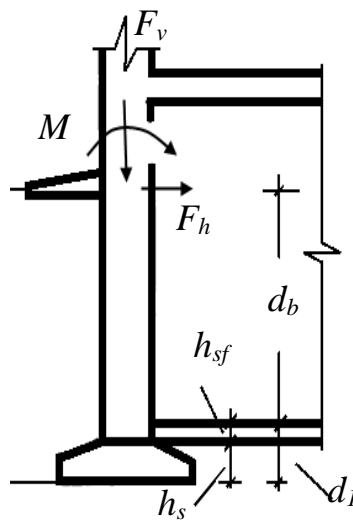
Схема фундаменту для будівель при наявності підвальних приміщень
